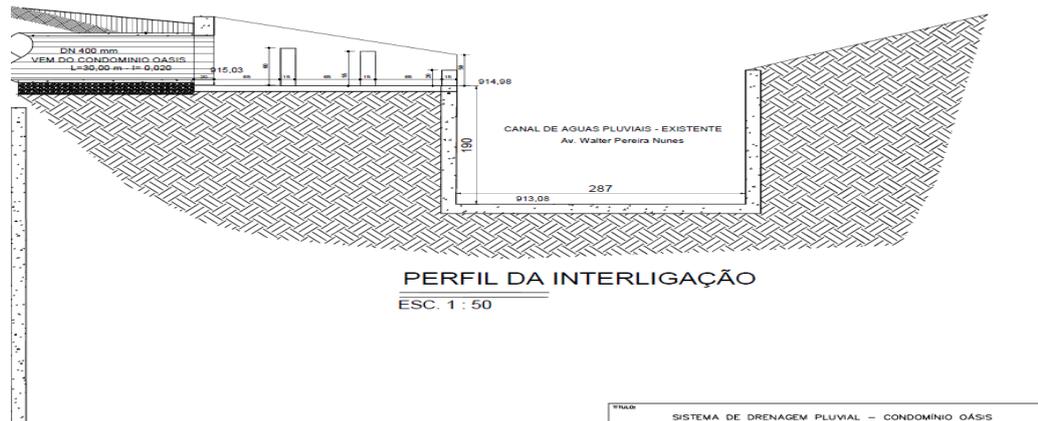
cópia do trecho projeto de drenagem pluvial, folha 2/03, que mostra a interligação da rede pluvial final do condomínio ao canal da Av. Dr. Walter Pereira Nunes.
